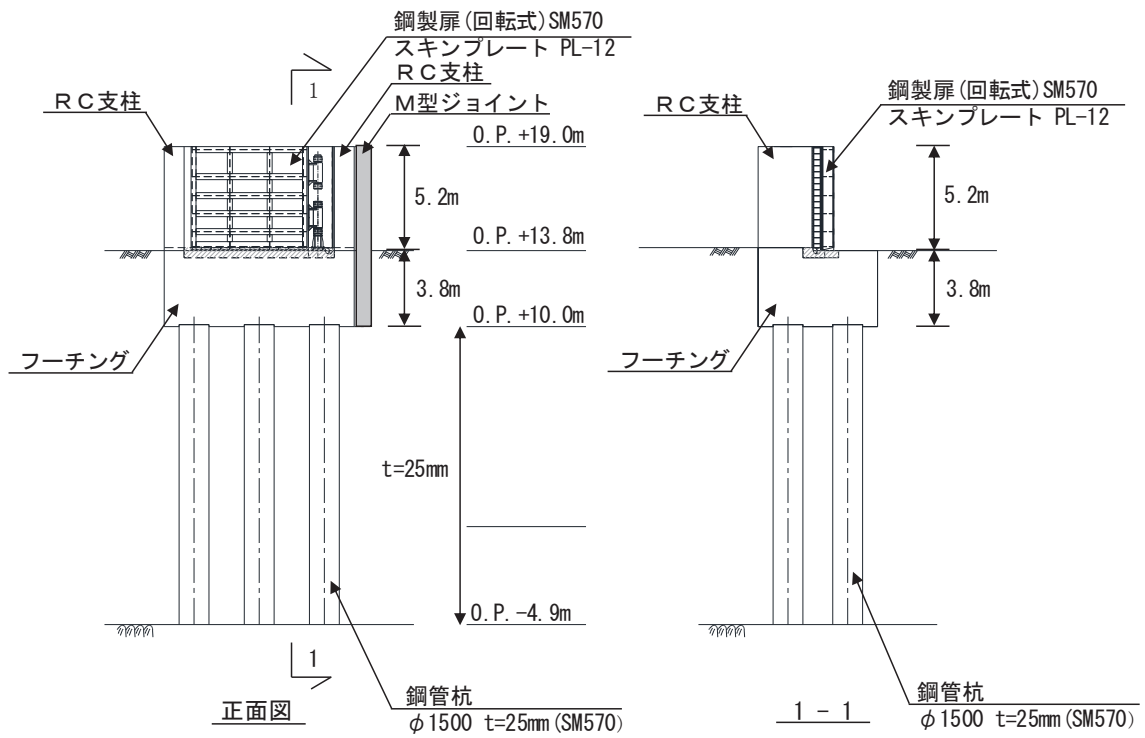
(1) 鋼製扉 2 の構造図 (正面図及び断面図, 平面図)
